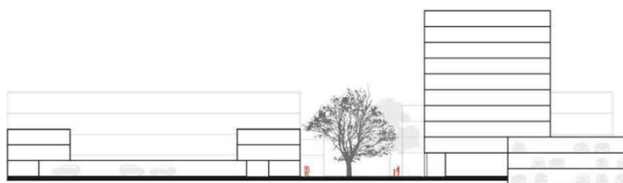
toename openbare ruimte gehele Havenkwartier
